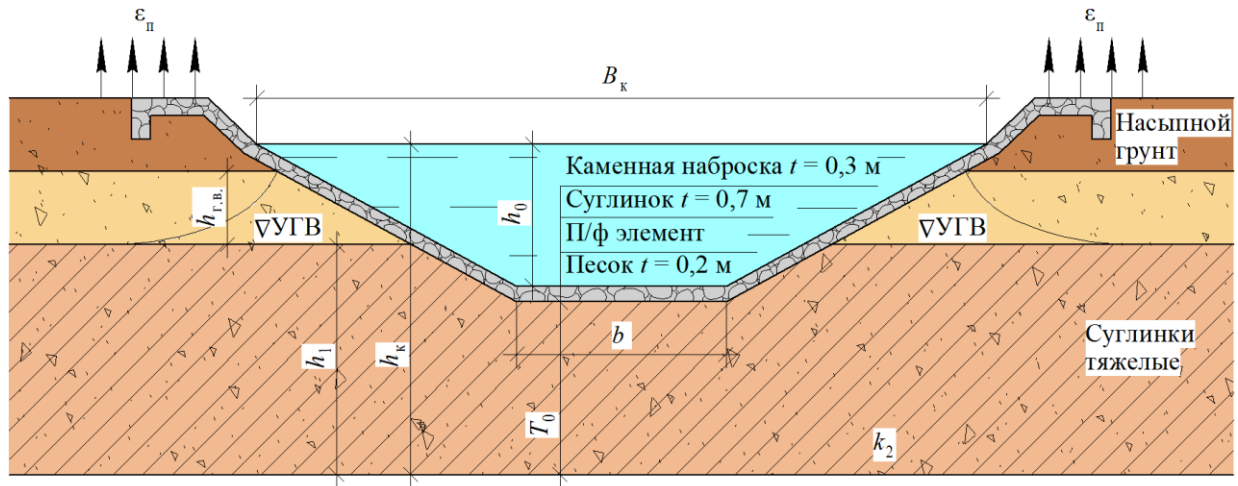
Расчетная схема сечения оросительного канала:
